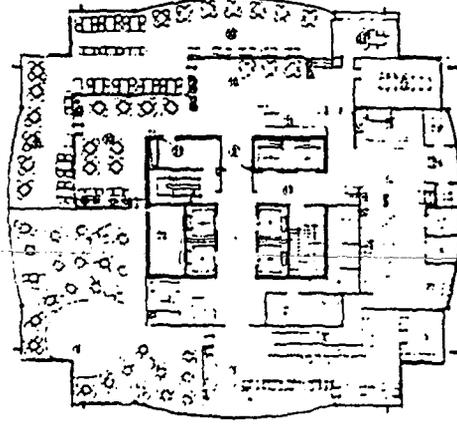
The Marmara Oteli Vaziyet Planı.
